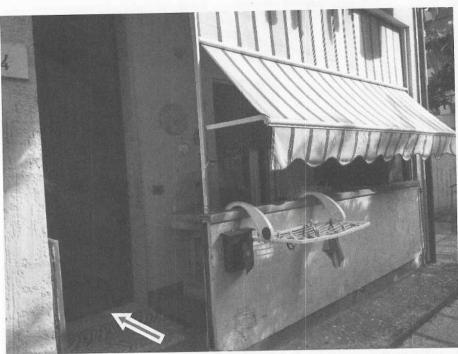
Vista della corte comune retrostante al piano terreno, del terrazzo e Dell'ingresso alla abitazione.
